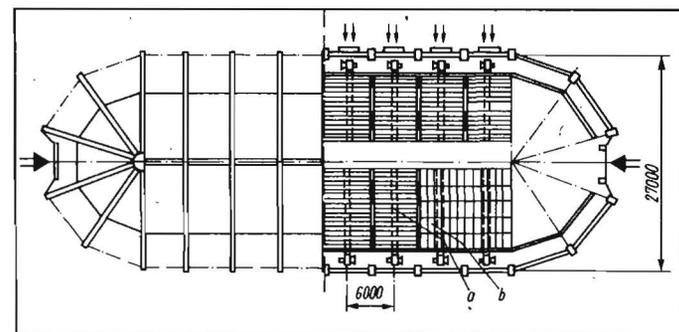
Grundriß der Bogenbinder-Membranhalle (links Stahlkonstruktion, rechts Belüftungsfläche mit Schlitzbrückenblechen b und Unterflurkanalsystem a)
